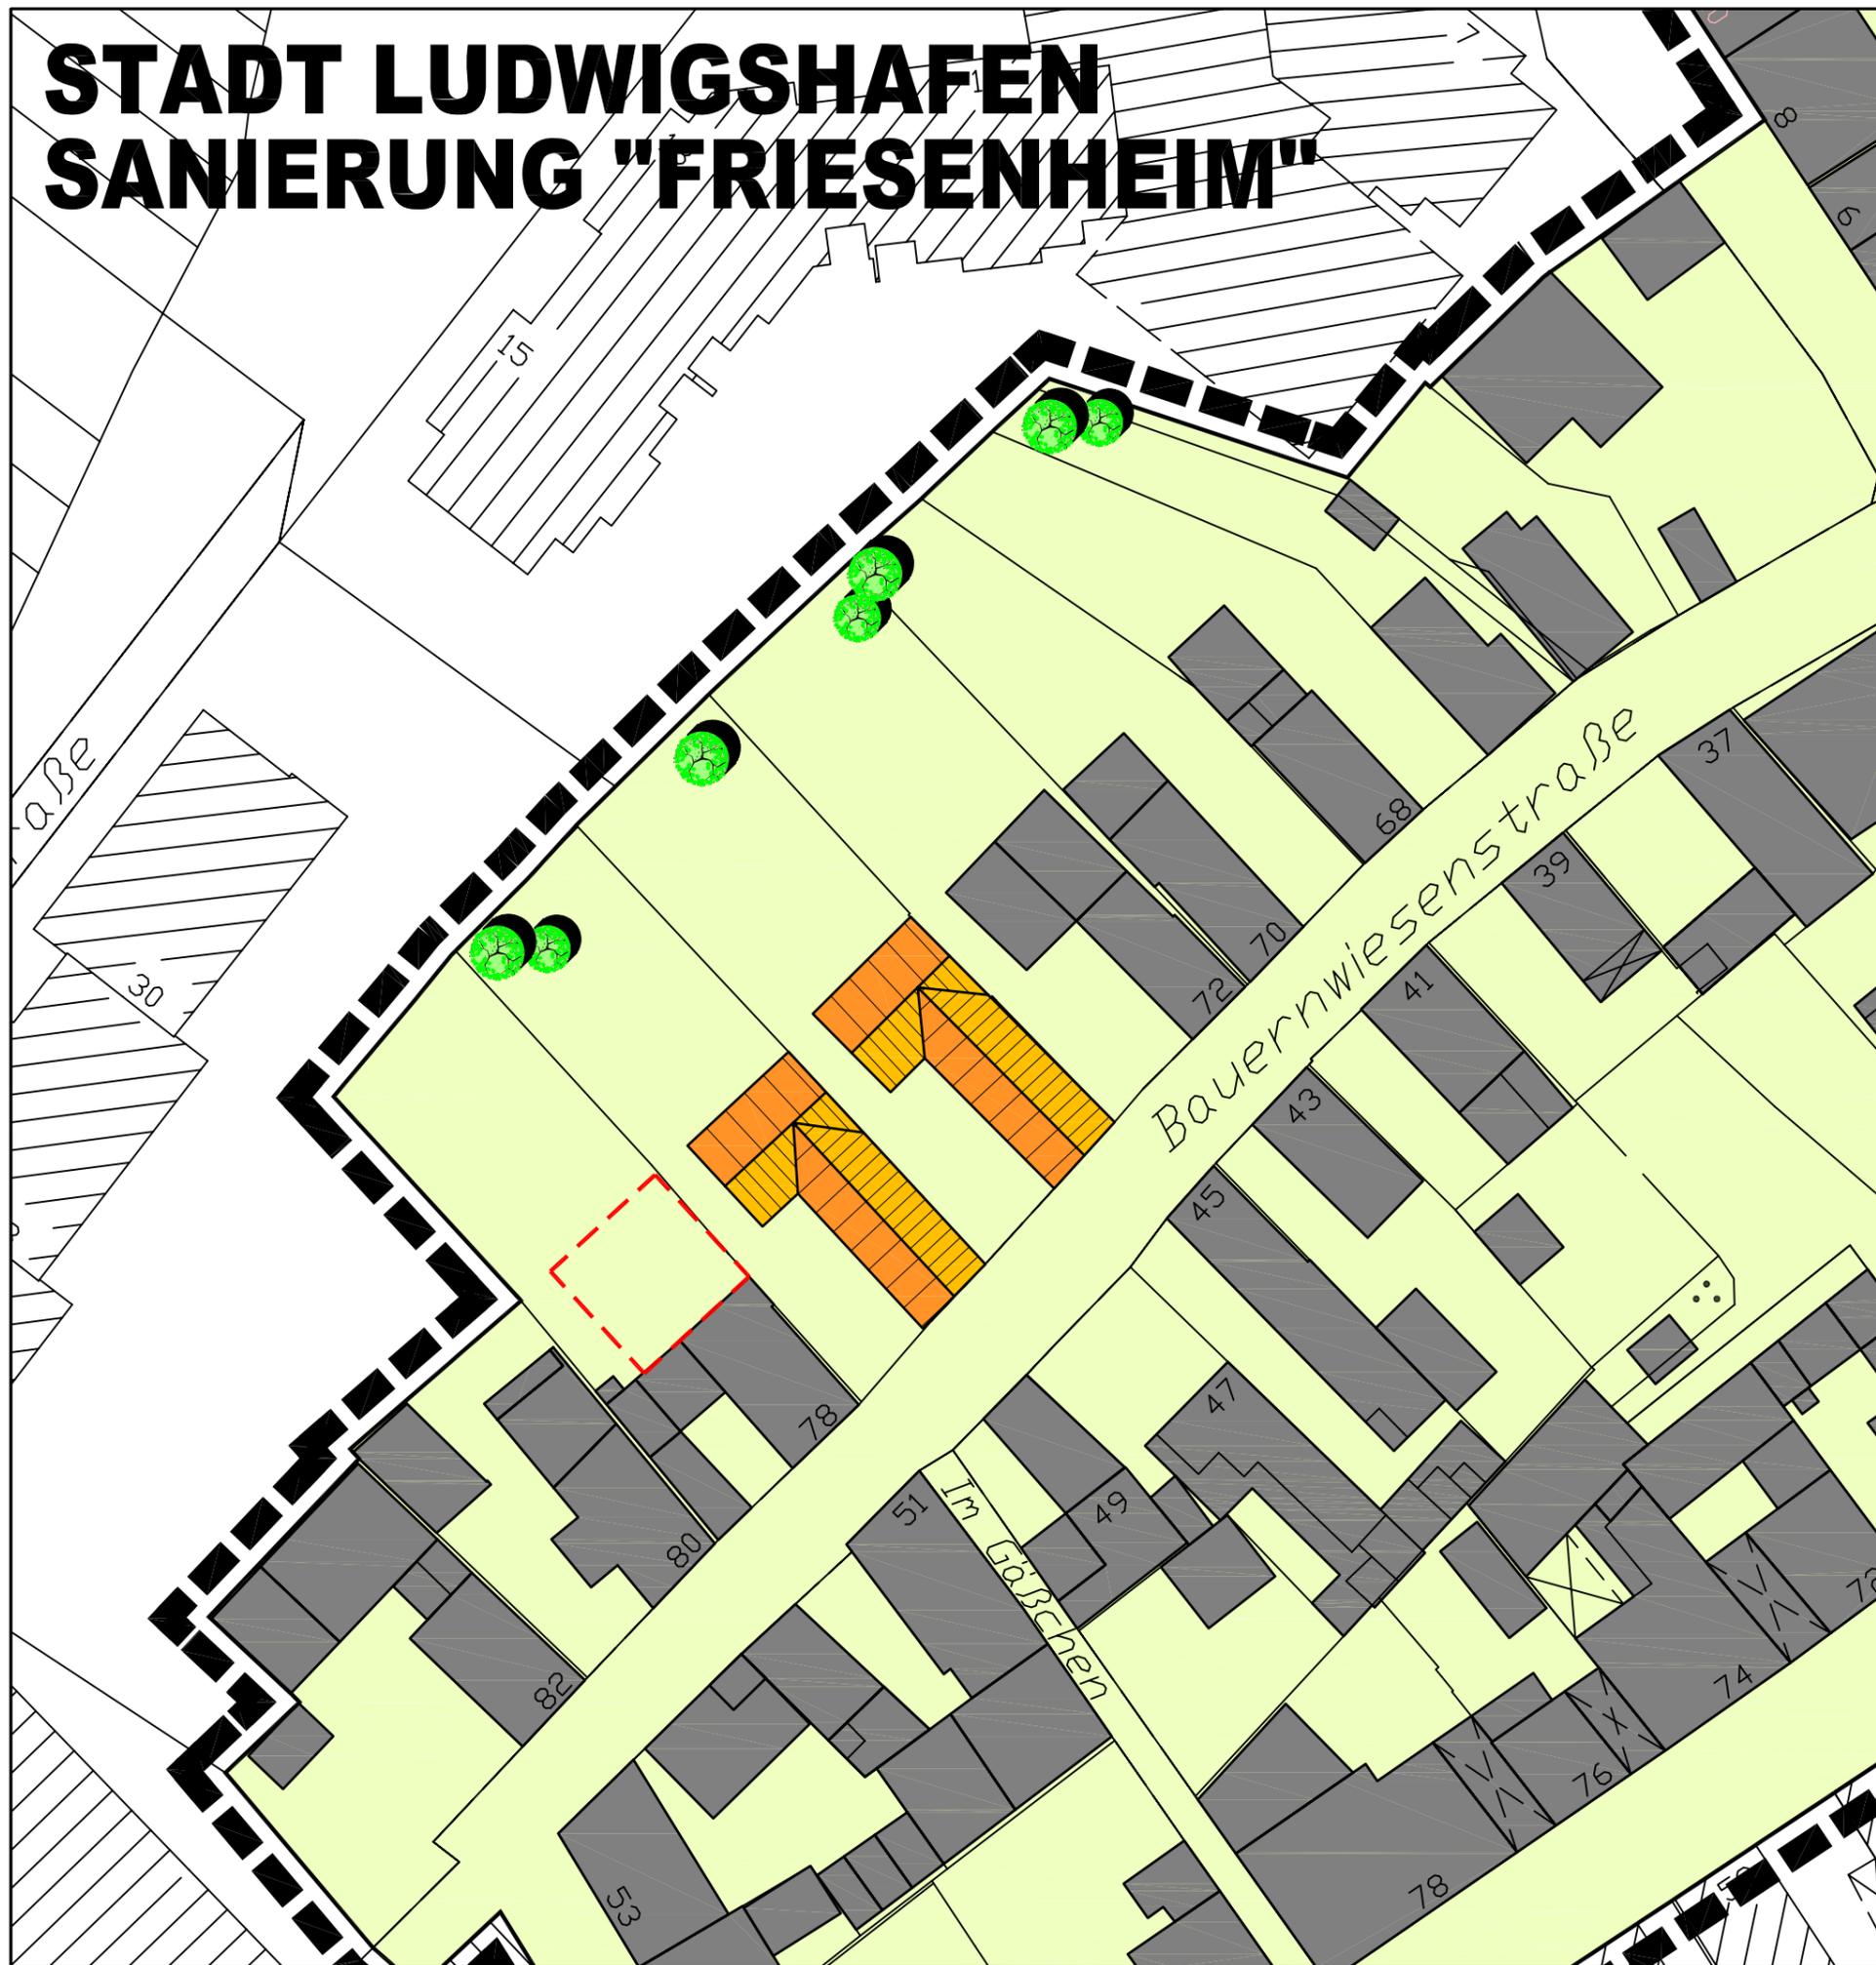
Bauernwiesenstraße 74 – 76: Darstellung im Rahmenplan 1997
